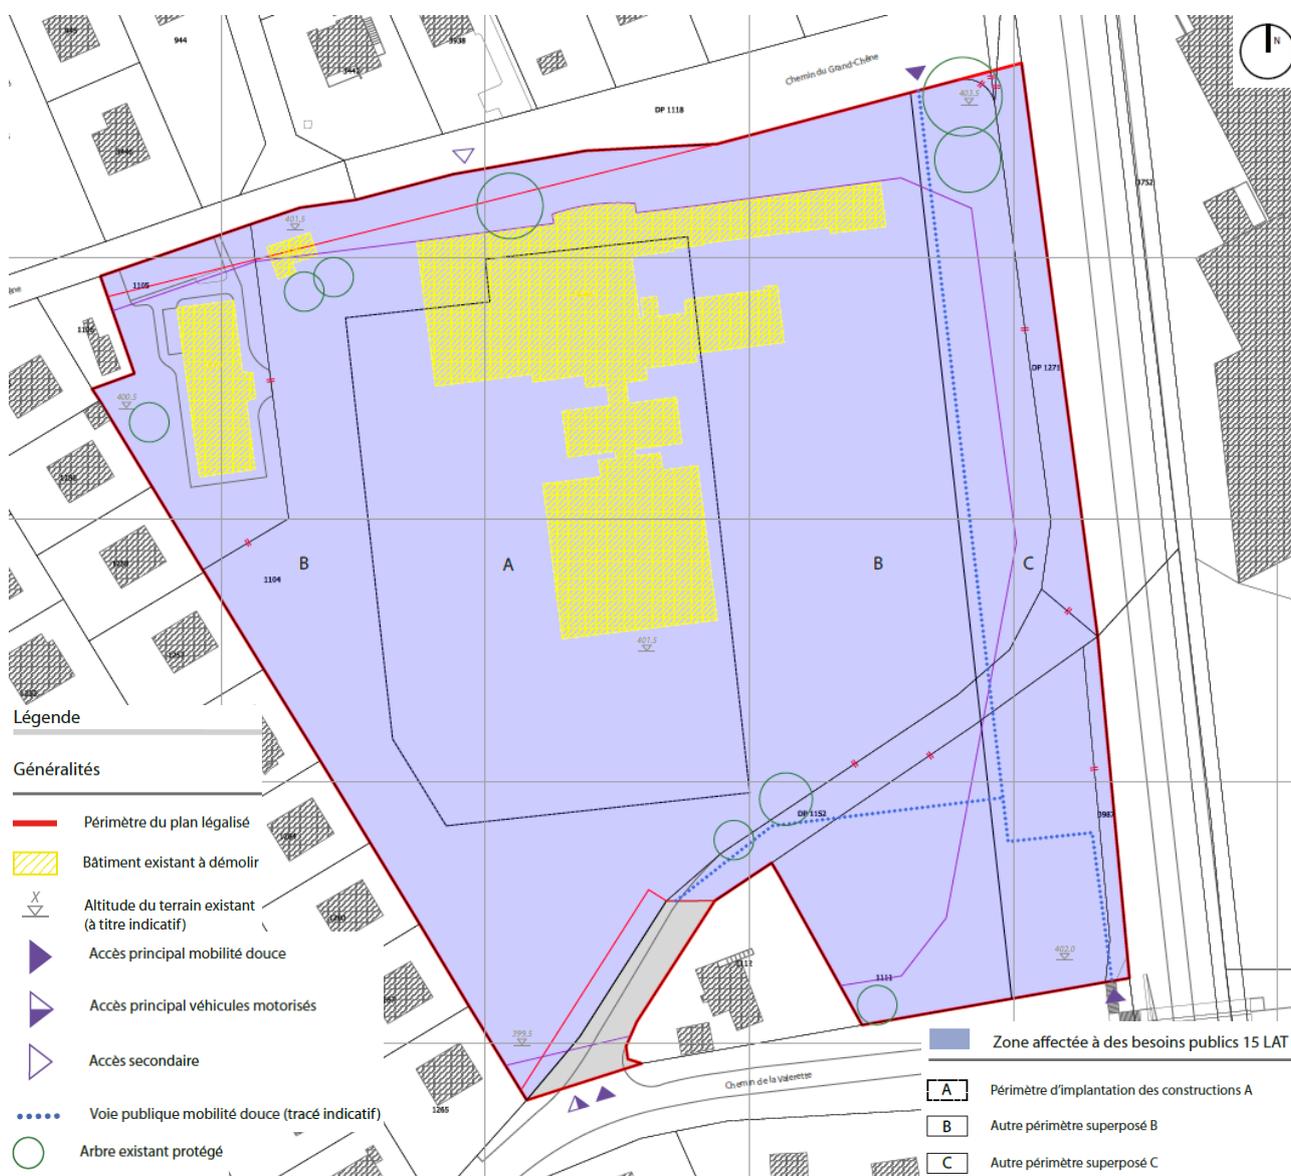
Extrait du plan « Plan d'affectation cantonal n° 366 « Gymnase du Chablais », Repetti Sàrl (21.03.2022)
